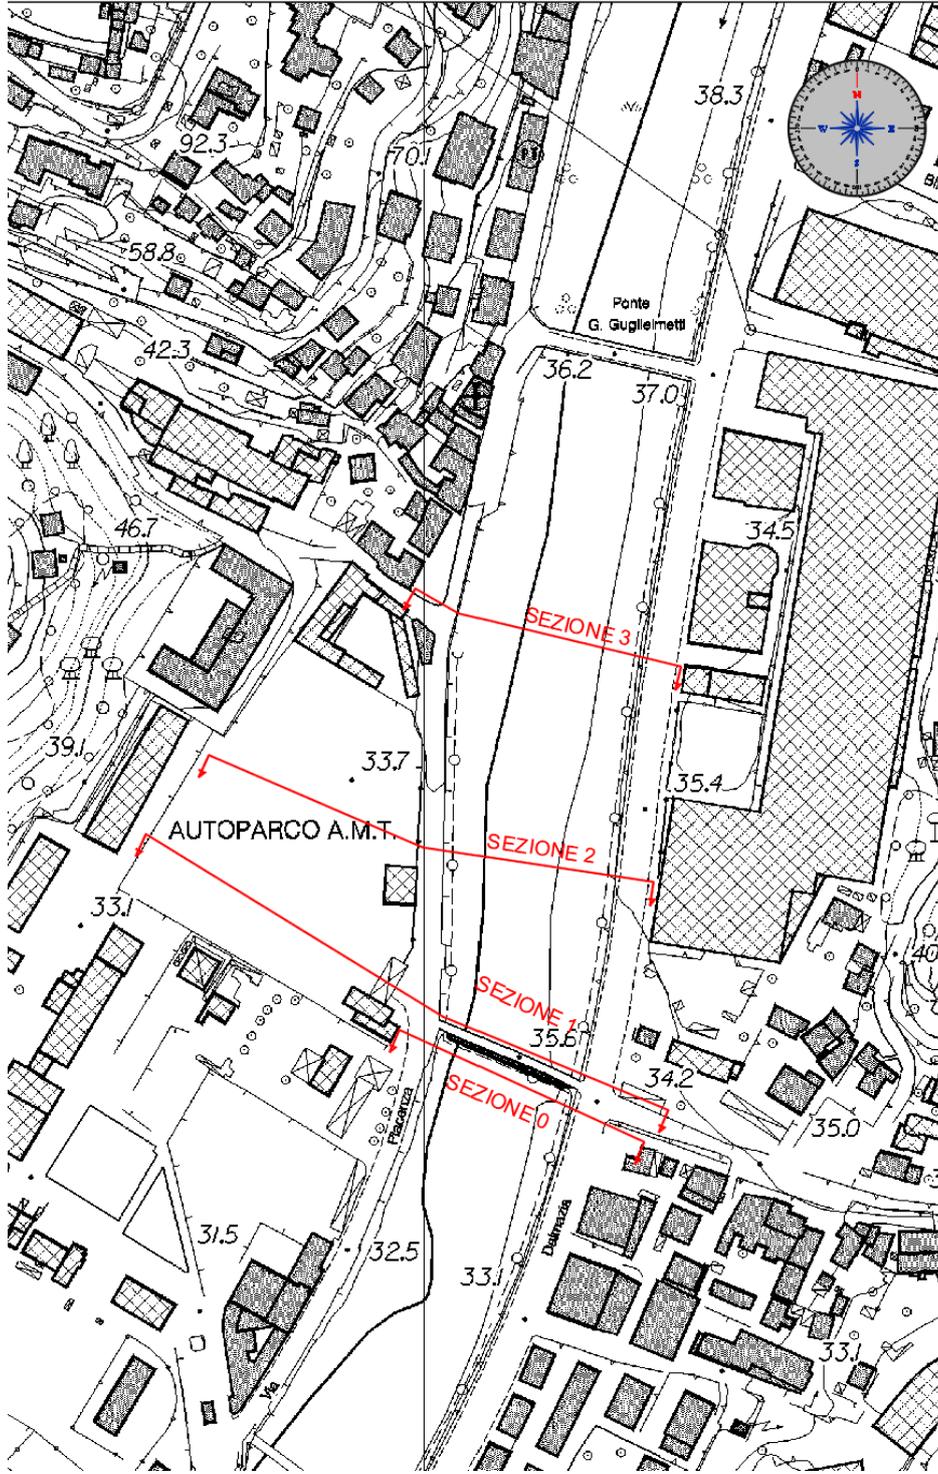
Rappresentazione planimetrica delle sezioni oggetto di rilievo di dettaglio
